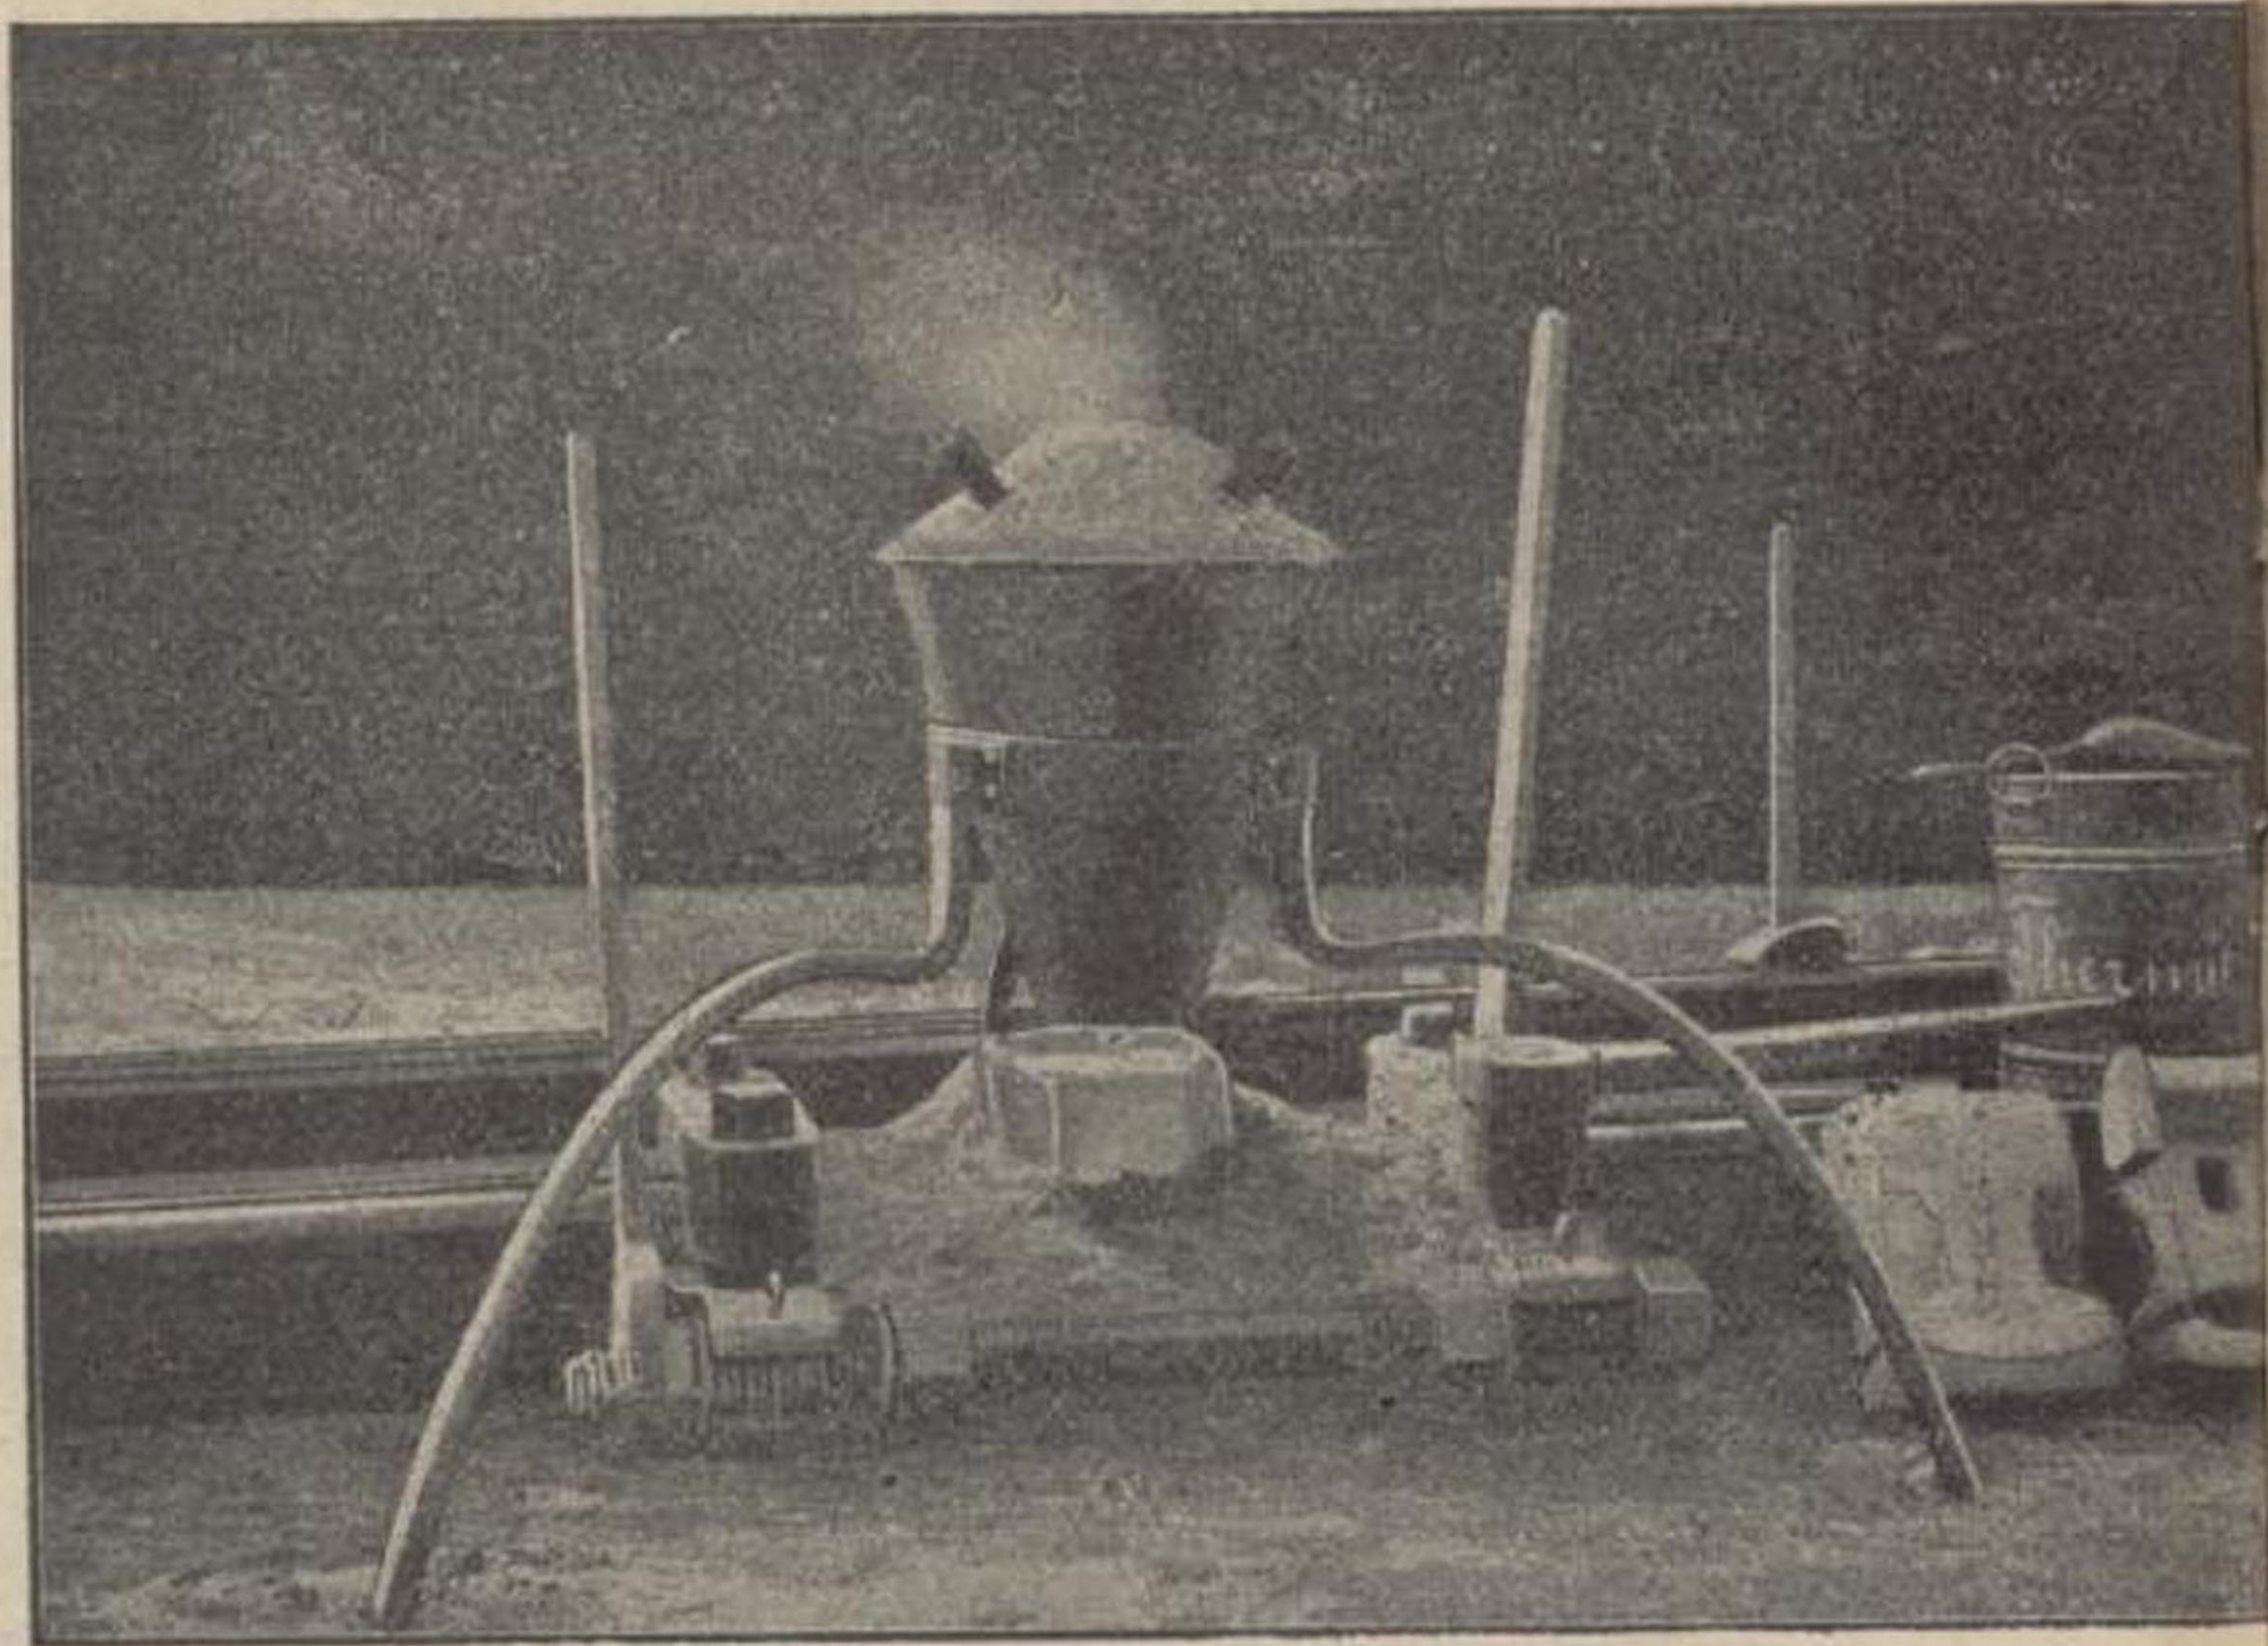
^a - *Soldadura de carriles.*—Los útiles y materiales necesarios.
